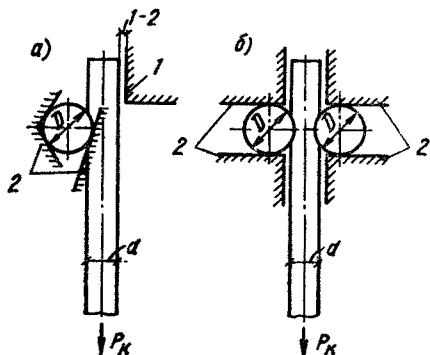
Схема испытания на срез контрольных образцов сварных крестообразных соединений
